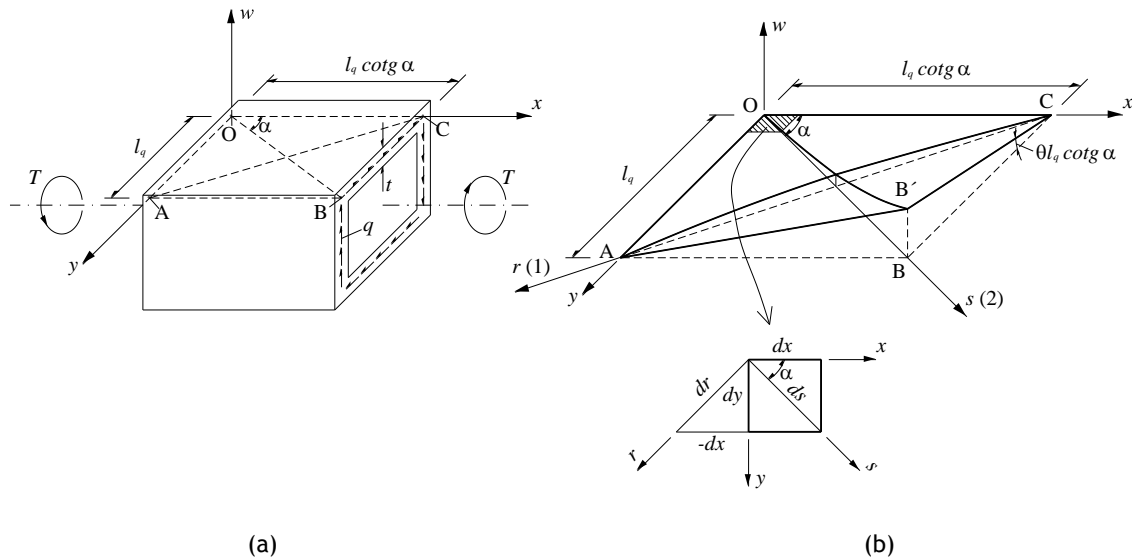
Flexão de uma escora e tirante de betão na parede de uma viga em caixão sujeita à torção [13]
